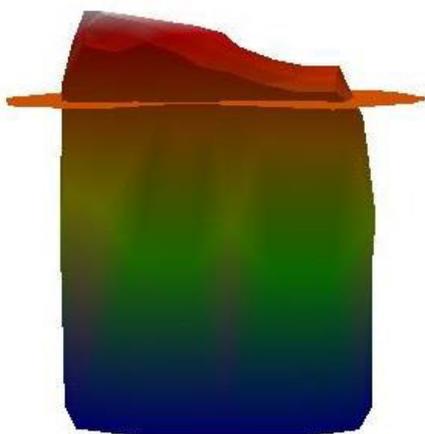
Modelo tridimensional do volume a ser escavado. A faixa em cor laranja, indica a interface da superfície do terreno.
